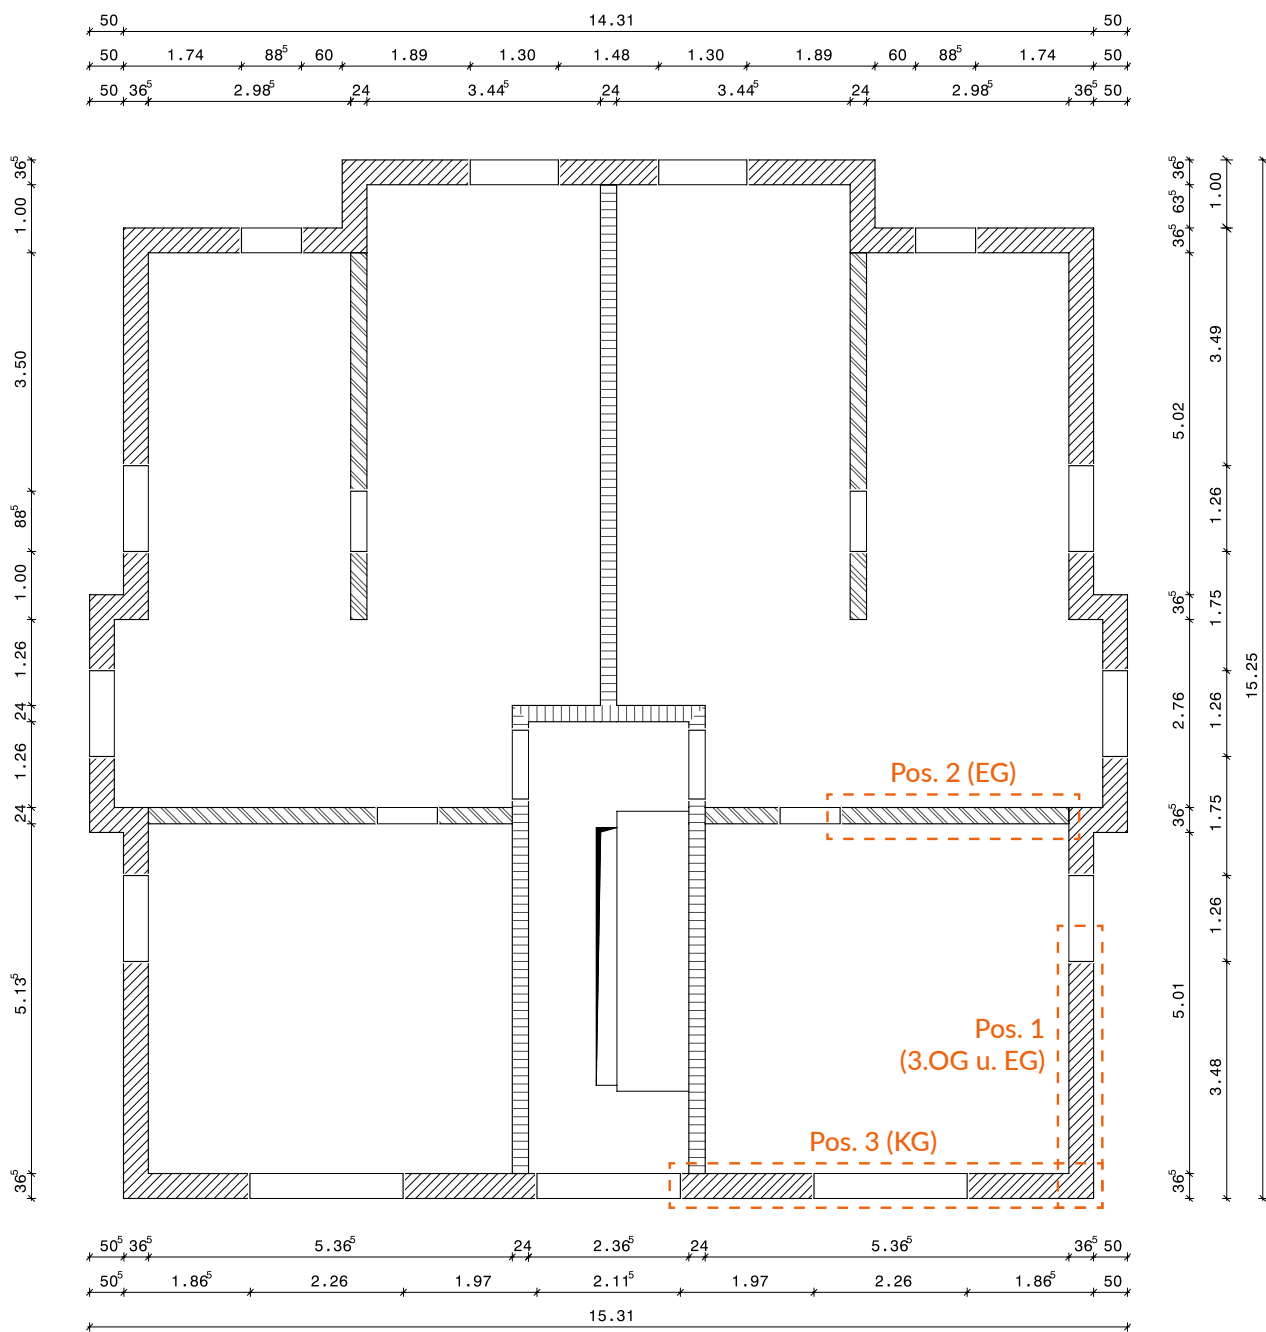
Grundriss der Geschosse EG bis 3. OG
